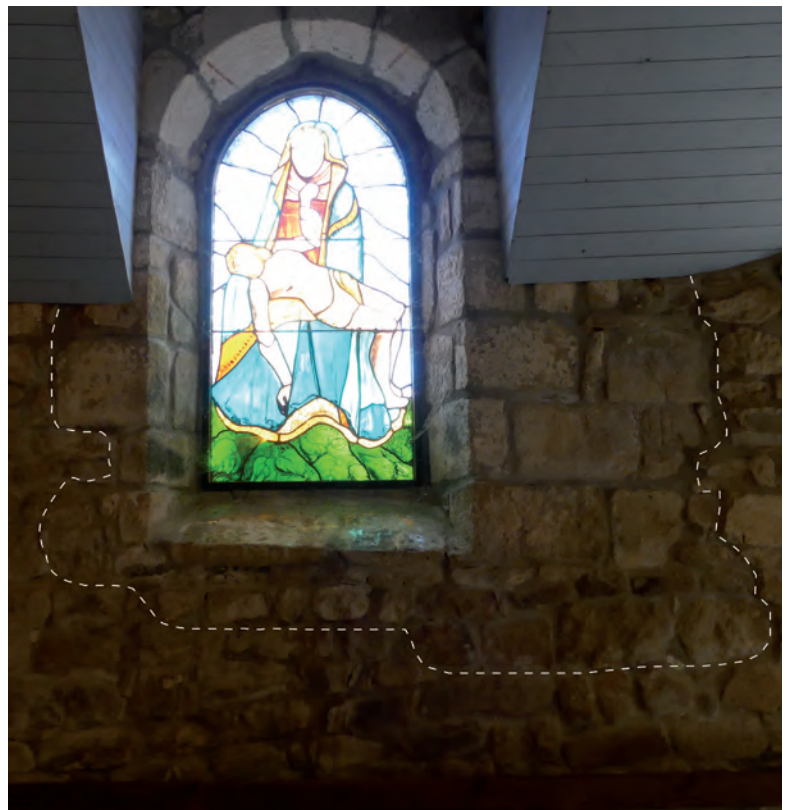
Fenêtre est du mur gouttereau sud © M. Millet, Inrap
